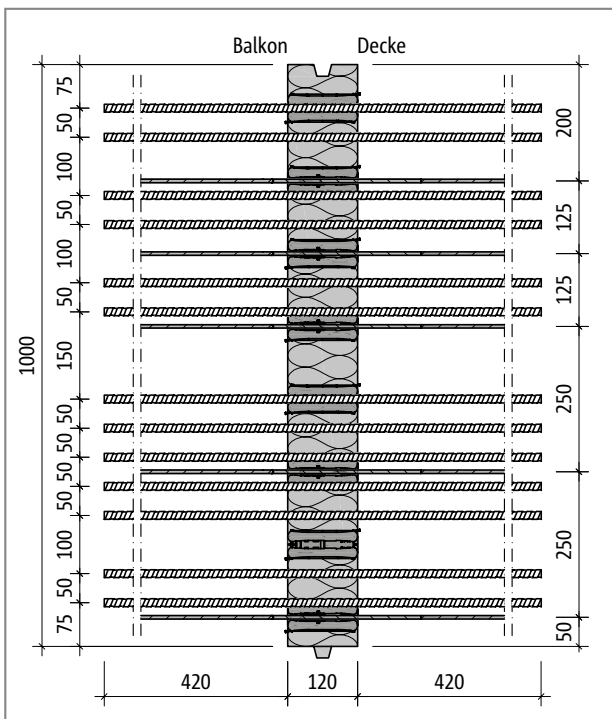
Schöck Isokorb® Typ KXT50-Combar-V6: Produktgrundriss
